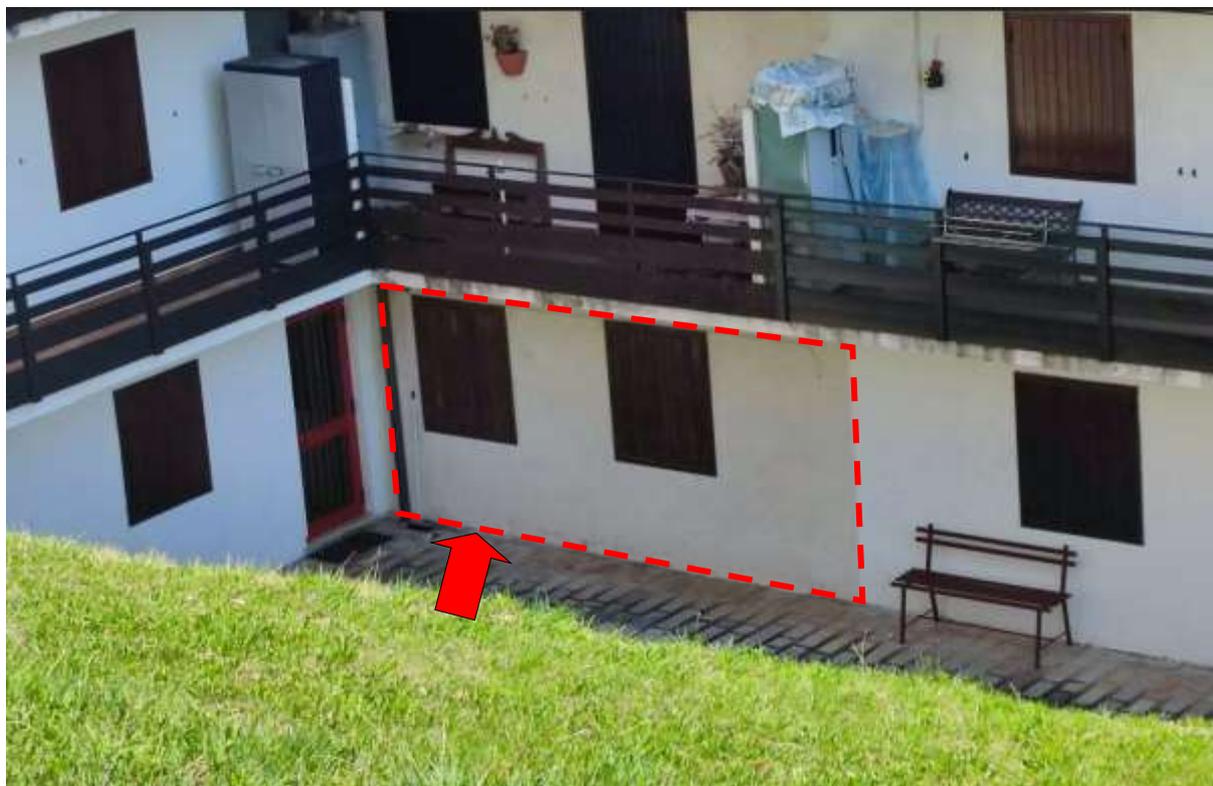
Ingrandimento vista da Ovest – alloggio pignorato
